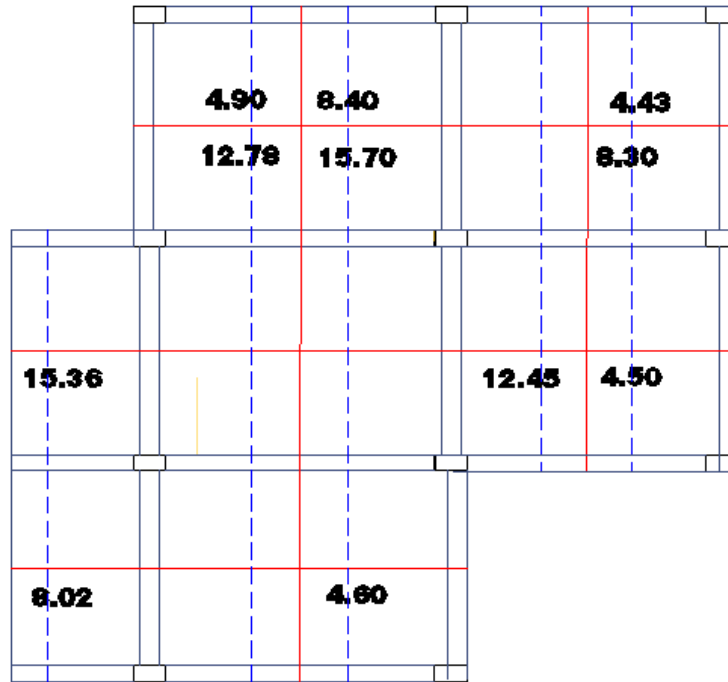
Ubicación en planta y área de tributaria de Columnas – Azotea.
